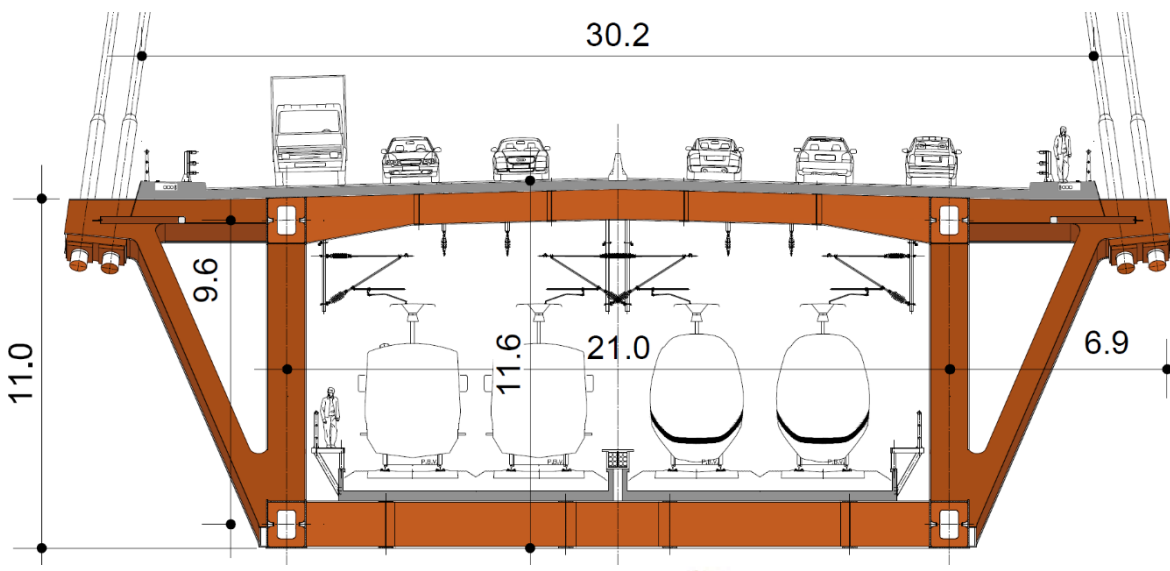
Proposta da secção transversal mista aço - betão, Eng.º Cândio Martins [90]
